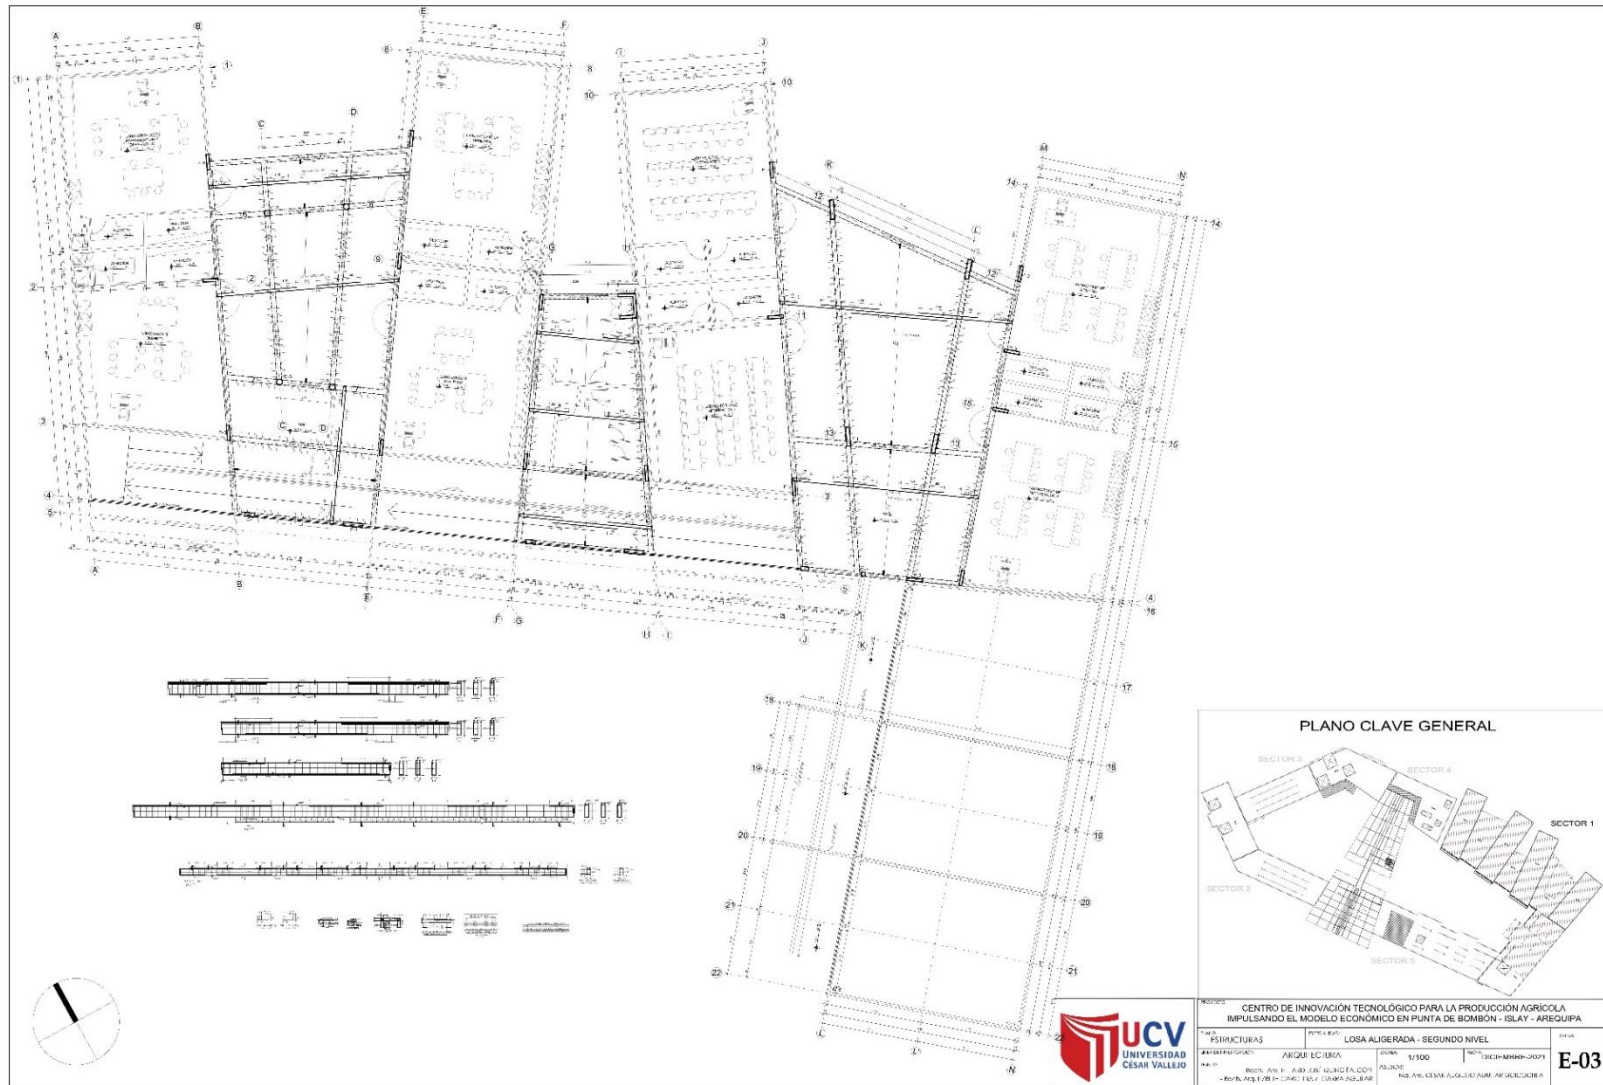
E – 03 Plano de Losa Aligerada de Segundo Nivel.
